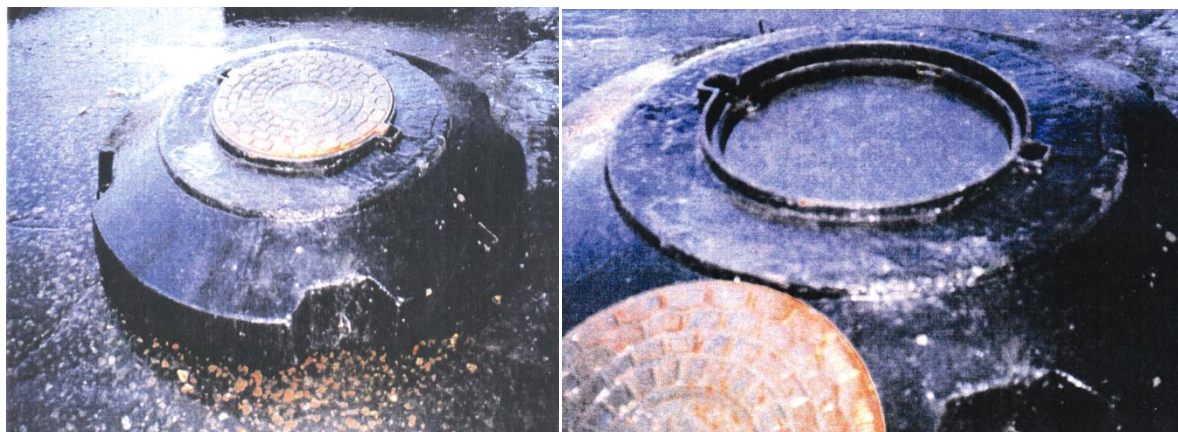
Опорная железобетонная плита для горловин смотровых колодцев
